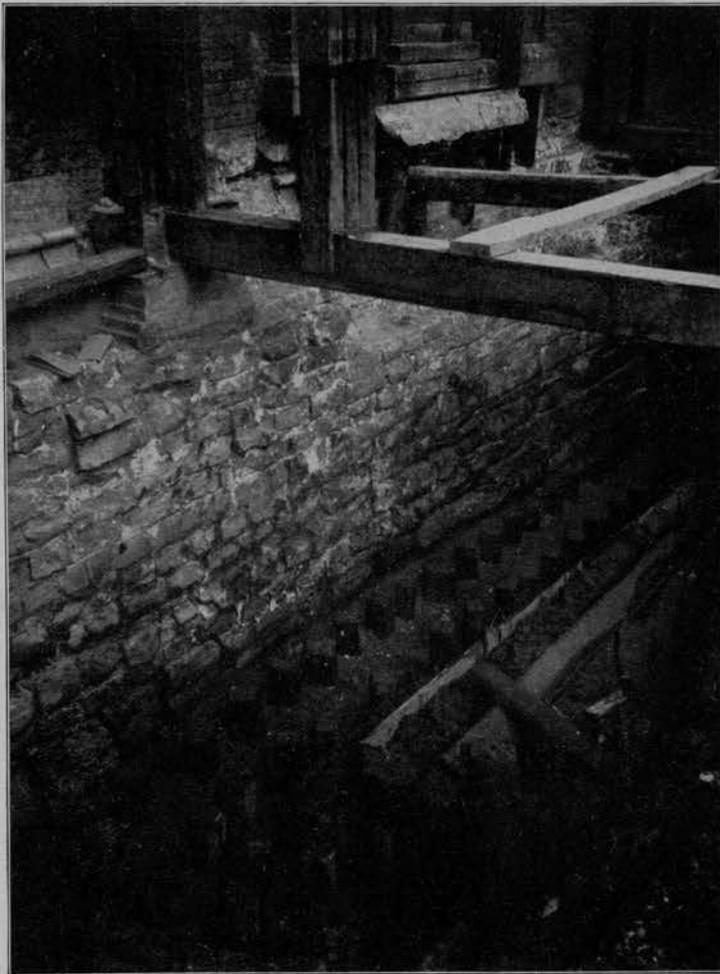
Rinforzo della fondazione sotto il muro del finestrone Vivarini.
